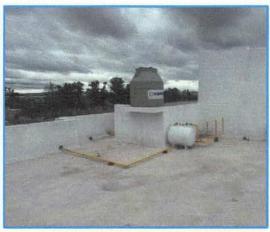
Instalación de tinacos y tanque estacionario en azotea.
